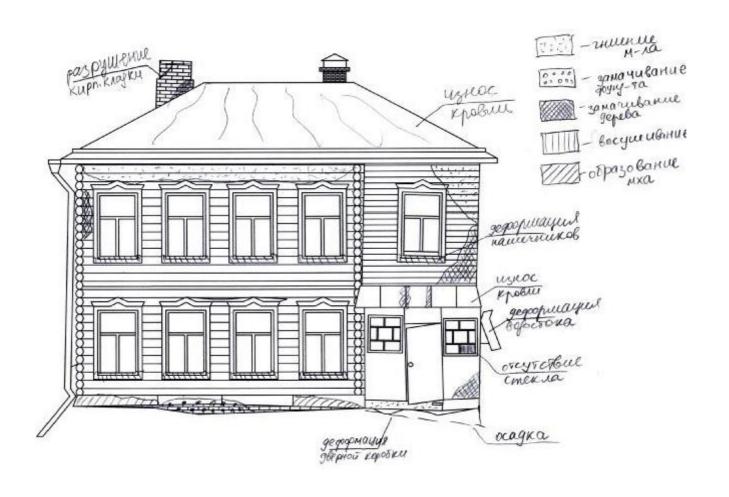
Дефектная карта фасада (здание рис.1,2).
